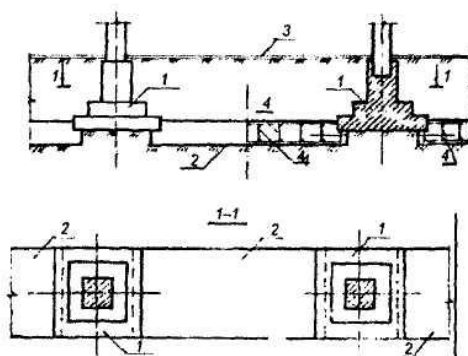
Переустройство столбчатых фундаментов в ленточные фундаменты
